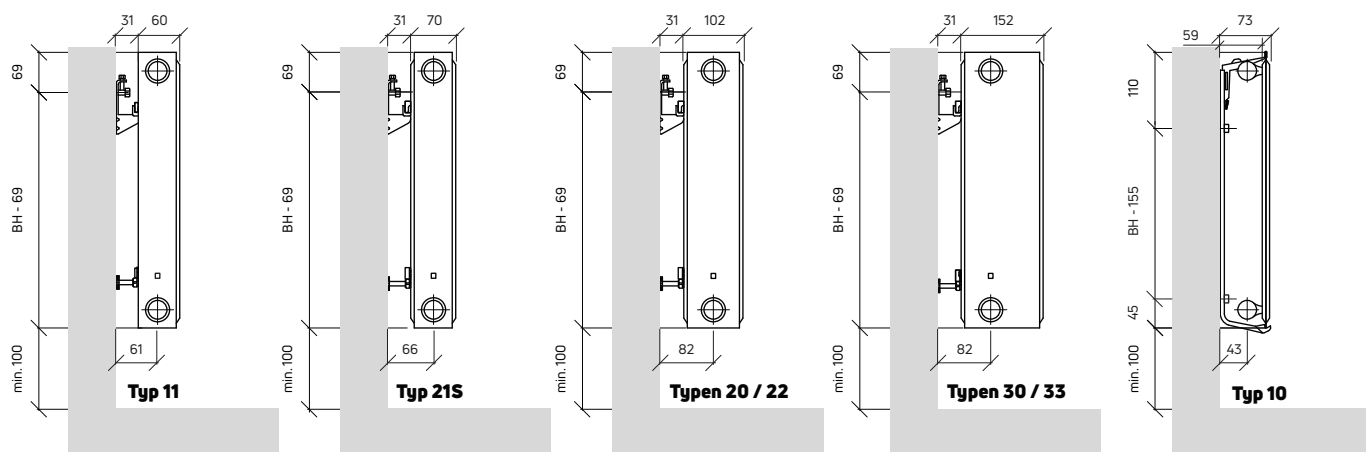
Montage Maße für Compact mit Befestigungslaschen
